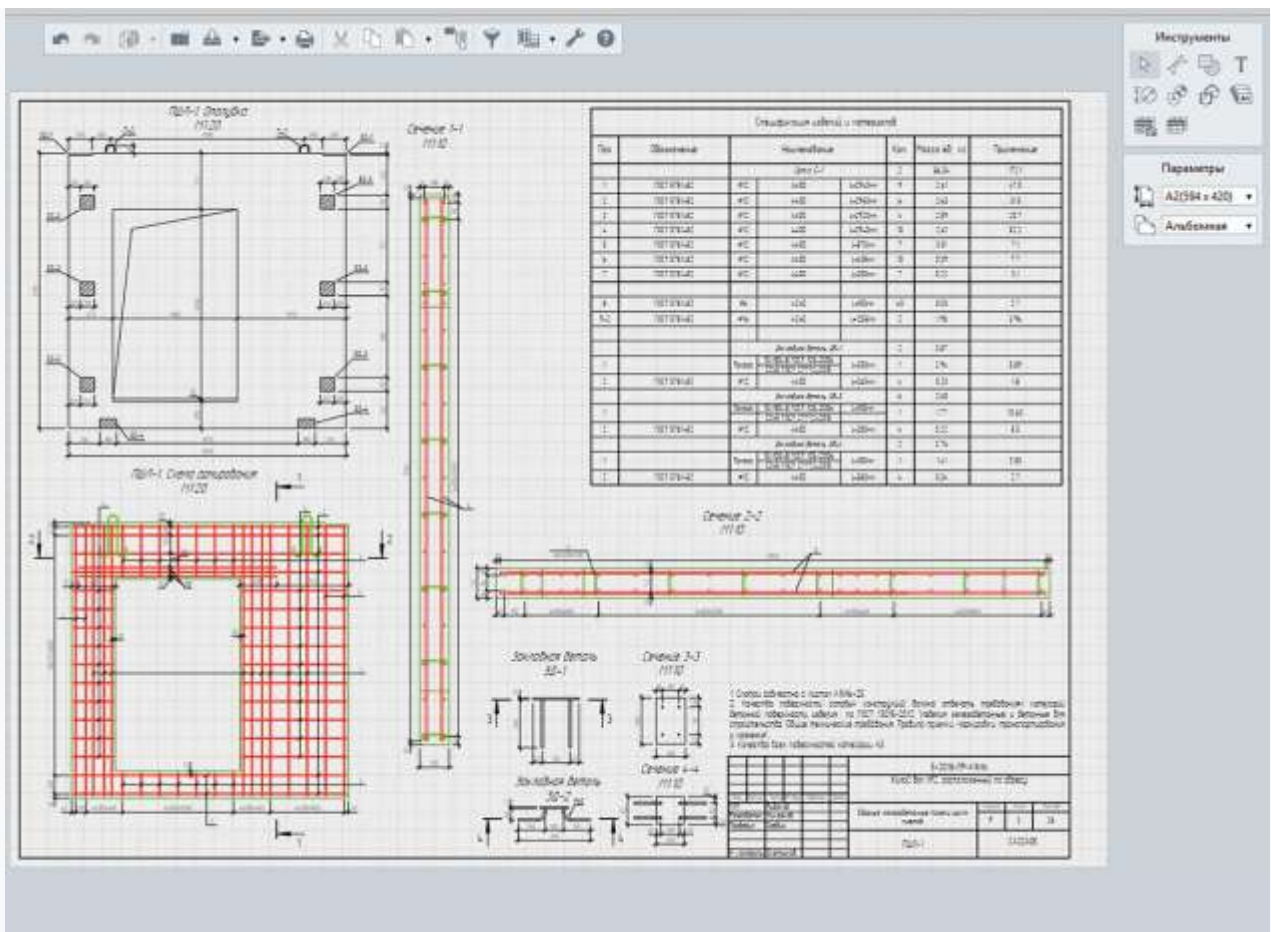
Чертеж. Готовый лист в Renga
